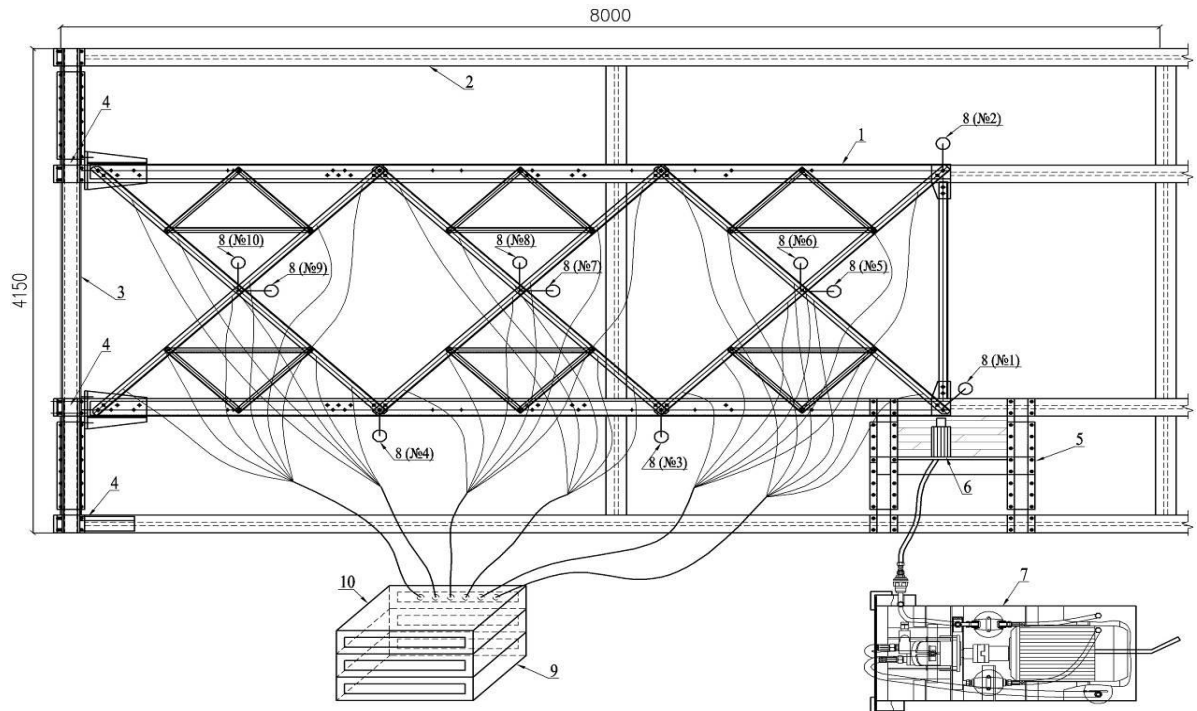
Схема экспериментальной установки: 1 – испытуемый фрагмент опоры ВЛ; 2 – металлический силовой постамент; 3 – опорный двутавр; 4 – подкосы; 5 – опорная конструкция под домкрат; 6 – гидравлический домкрат ДГ-10; 7 – маслостанция ручная с манометром; 8 – прогибомеры Максимова и 6ПАО; 9 – тензометрическая система СИИТ-3; 10 – блок коммутаторов
